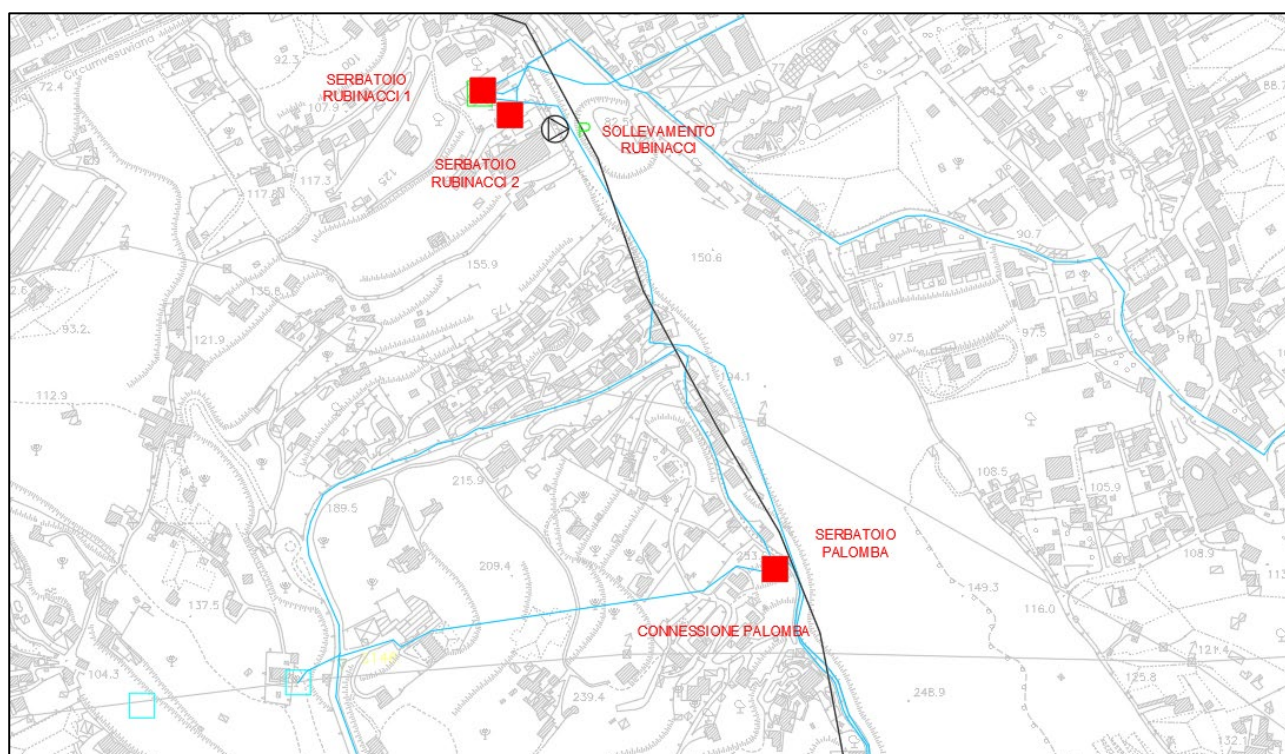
Planimetria Intervento Rubinacci - Palomba
